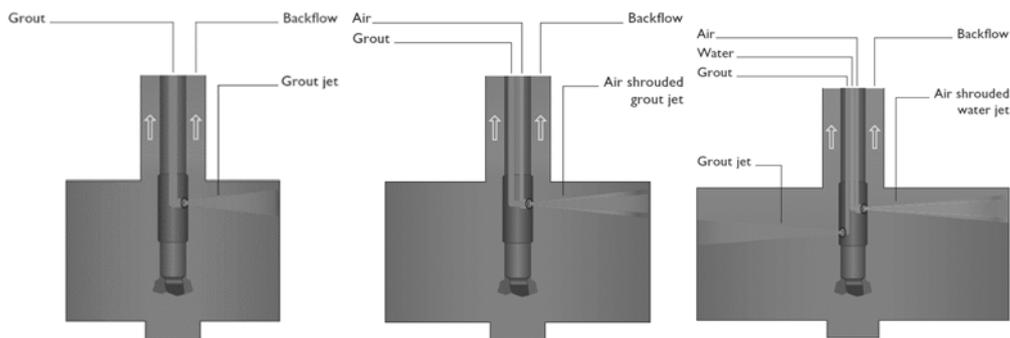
Sistemas de jet-grouting: Jet1, Jet 2, Jet 3 [7]
